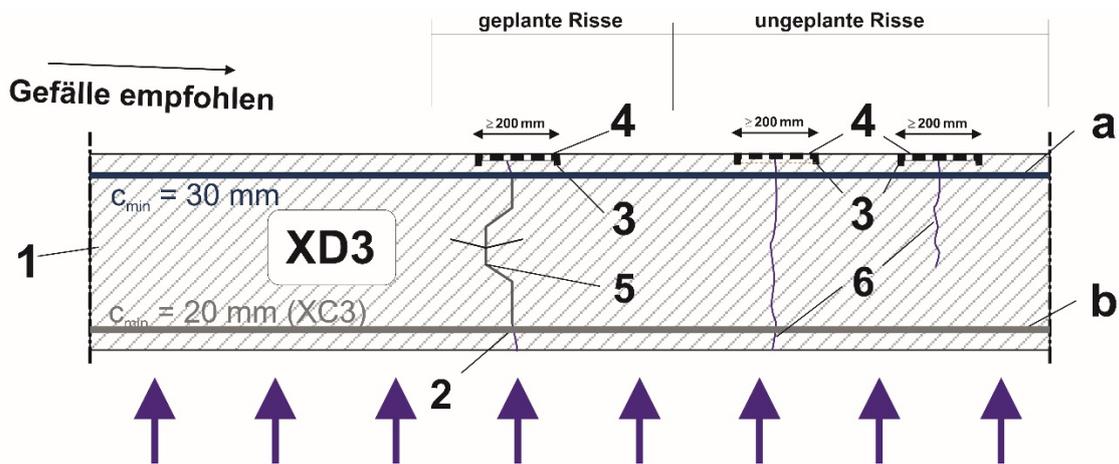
Parkdeck Ausführungsvariante A – ohne flächiges Oberflächenschutzsystem oder Abdichtung Variante A2 – Beton direkt beansprucht, lokaler Schutz der Risse
